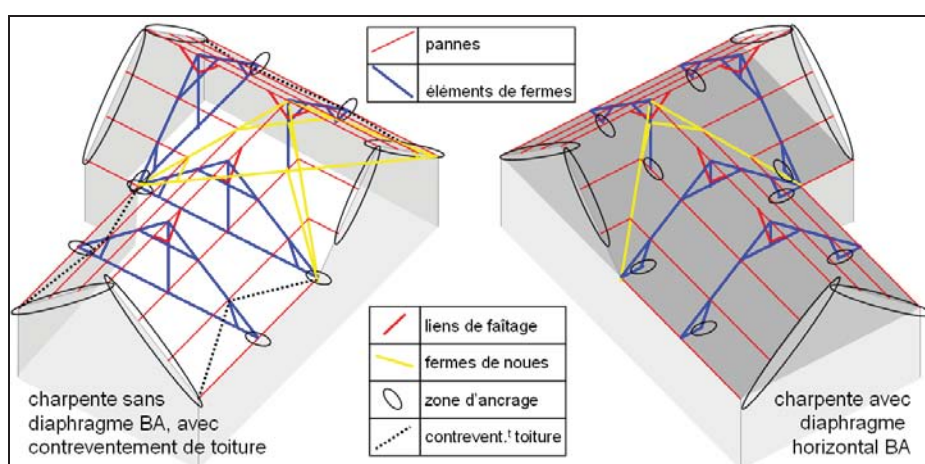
Un plan de contreventement d'une charpente traditionnelle en L [AFP 05]
